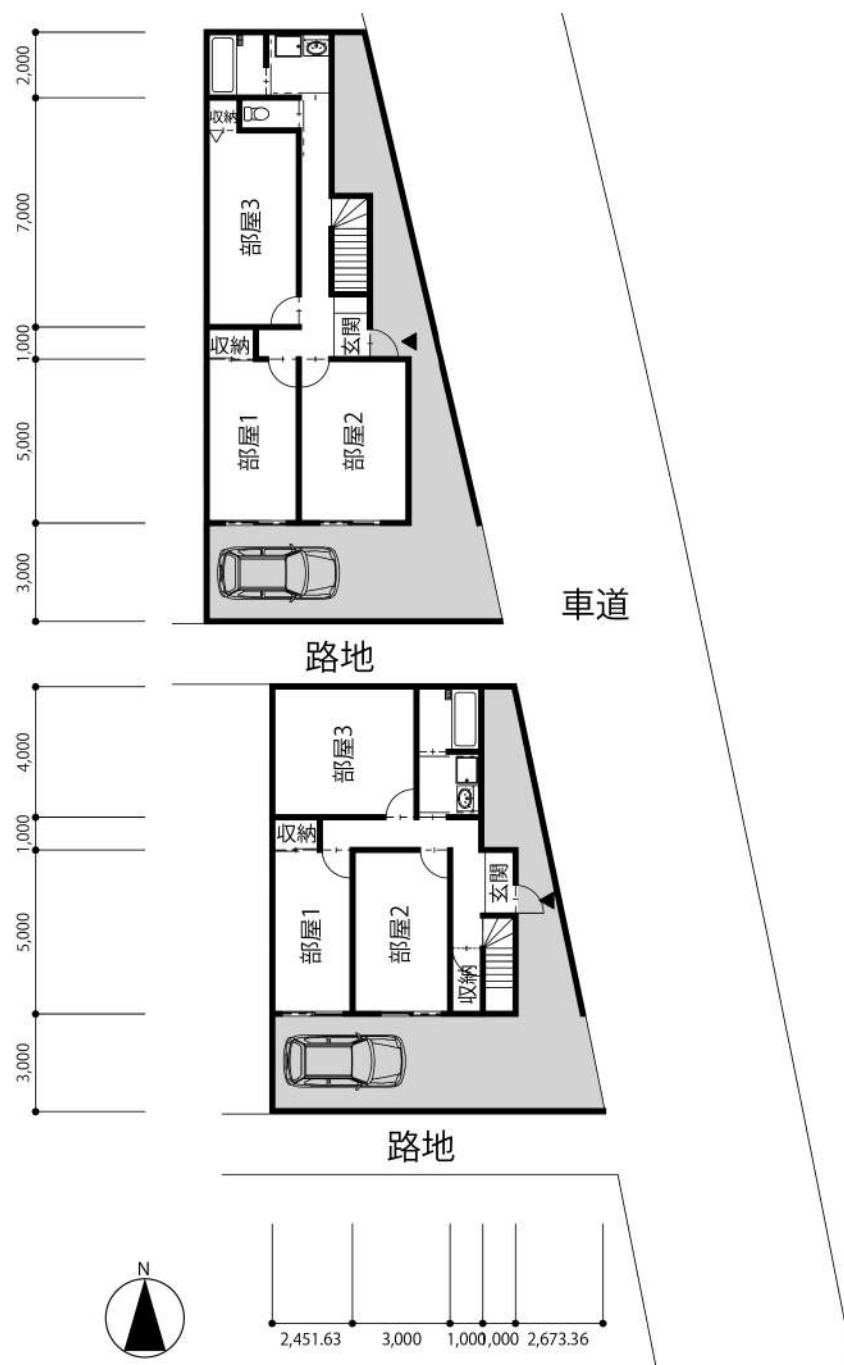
区画道路（車道）を生かした住居 1 階平面図
